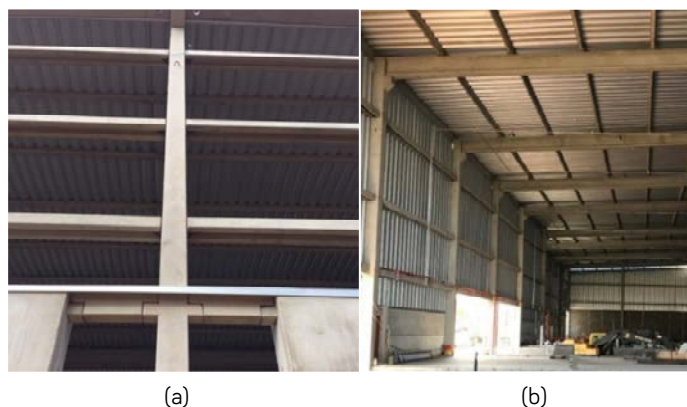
Vigas U apoiadas nos pilares (a) para fixação das telhas metálicas de fechamento lateral (b). Fonte: Elaborado pelo Autor
